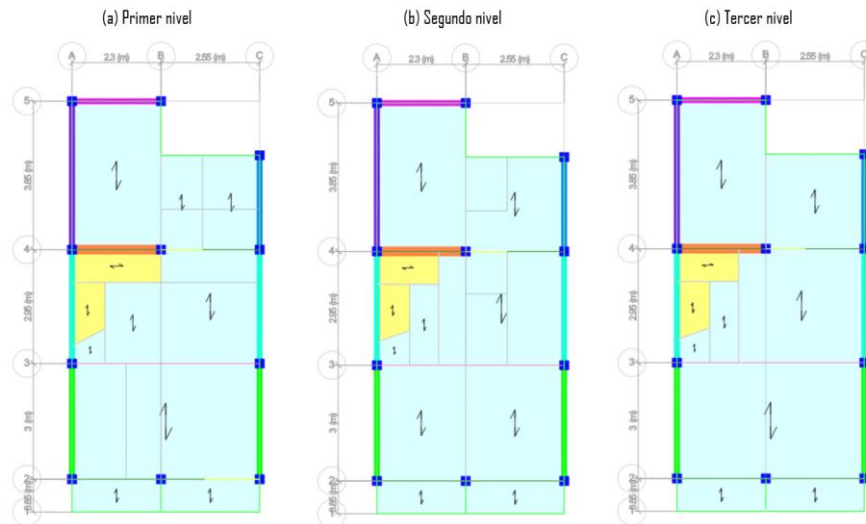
Dirección de las losas aligeradas y escaleras (Fuente: propia)
